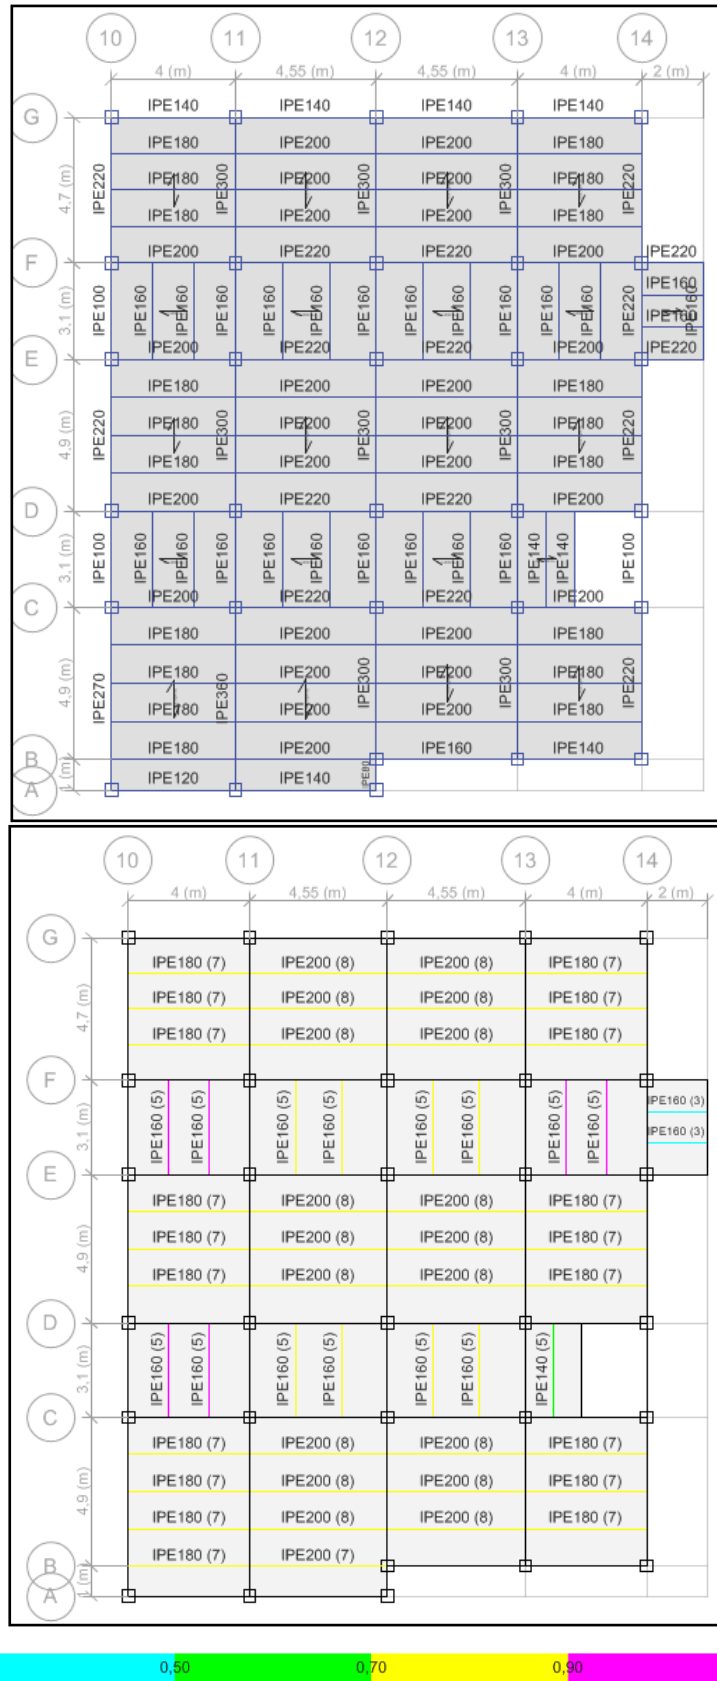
Demanda/Capacidad viga secundaria de planta alta bloque 3
